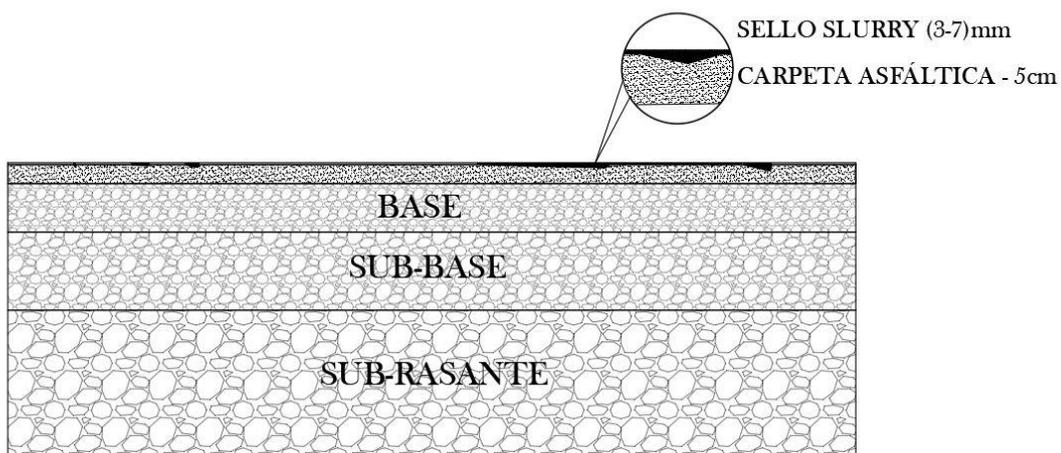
Esquema de pavimento flexible con sello Slurry Seal Tipo II.
